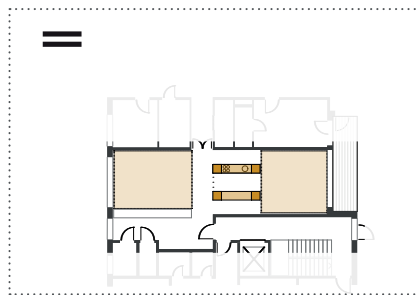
Skizze Bereichsleitung | Grundriss um eine Achse gekürzt
